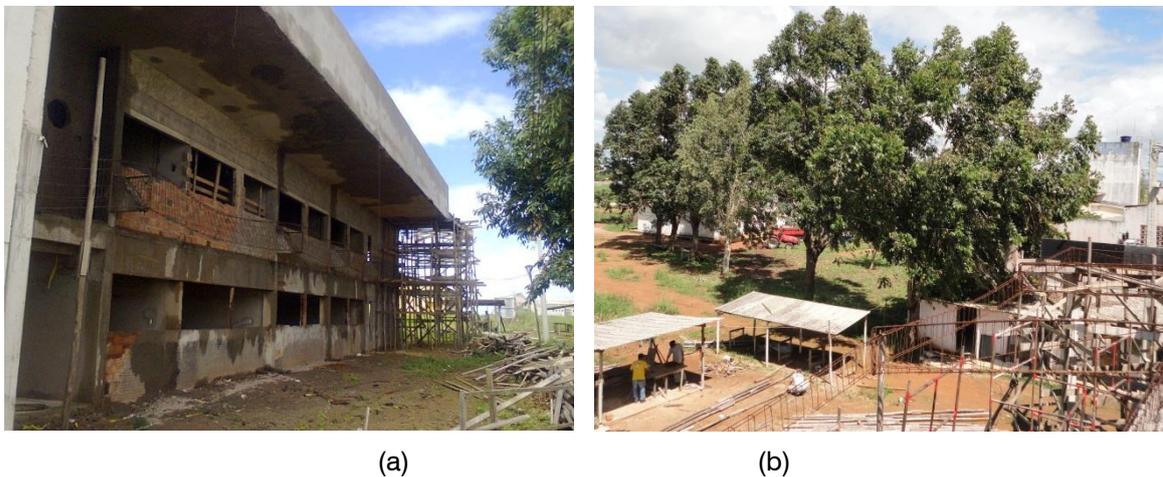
Obra do bloco D: (a) fachada principal – leste, e (b) vista superior do canteiro de obras, a partir da laje de cobertura.
